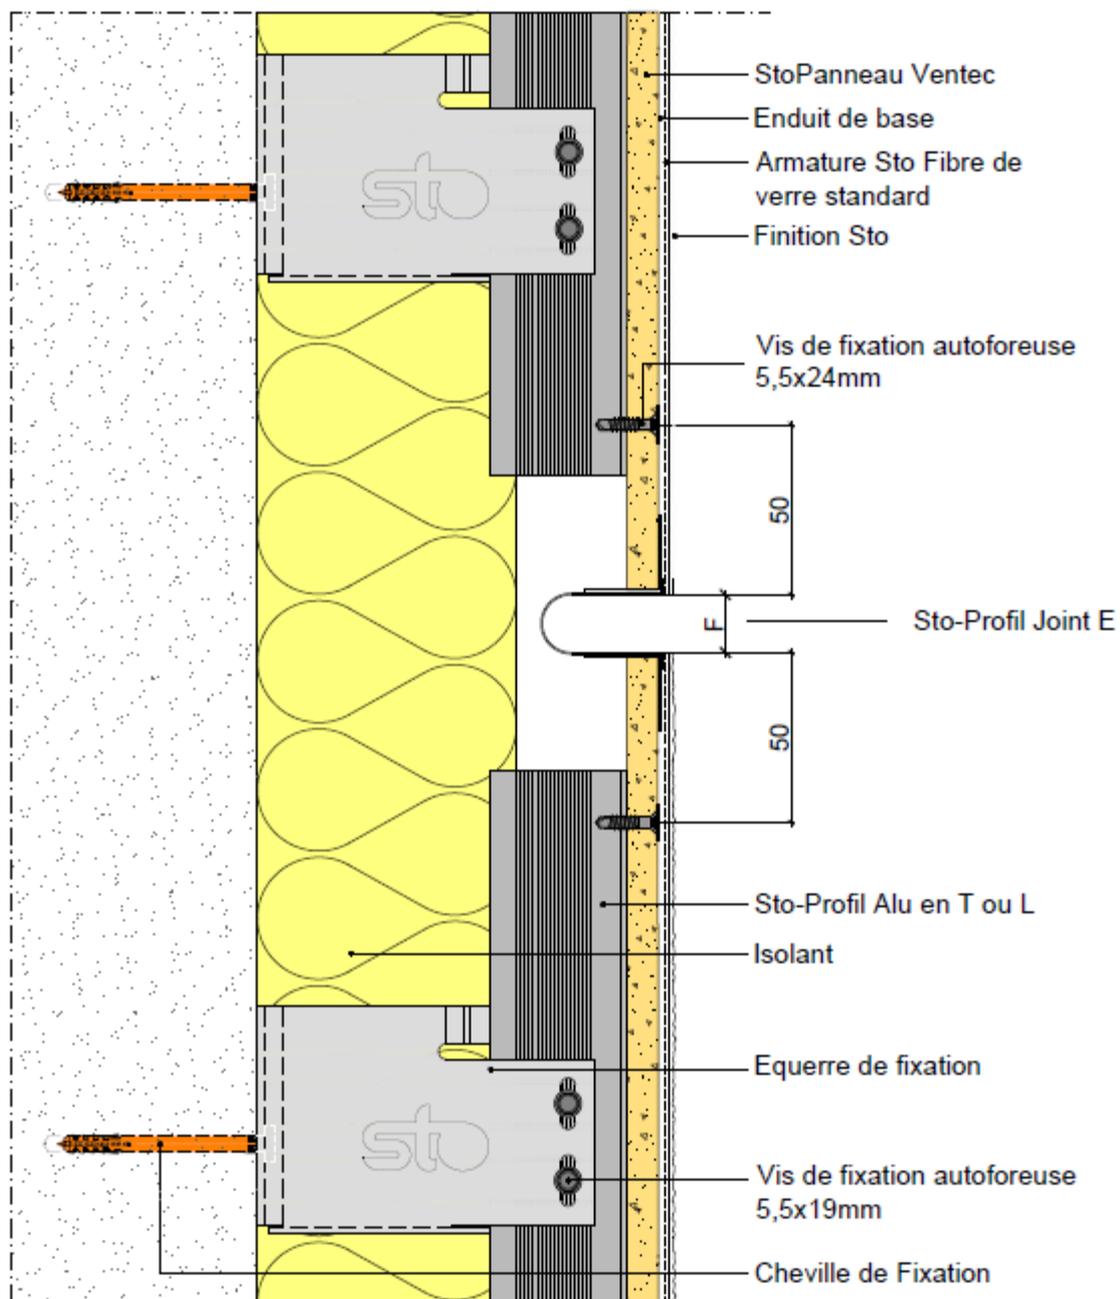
Coupe verticale - Fractionnement à joint fermé - Ossature aluminium
